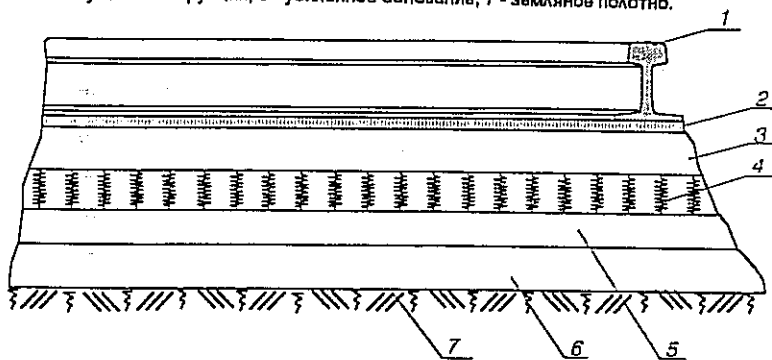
б - 1 - рельс; 2 - упругие непрерывные подкладки; 3 - подрельсовая конструкция - непрерывная балка; 4 - основная несущая конструкция; 5 - усиленное основания; 6 - земляное полотно.
